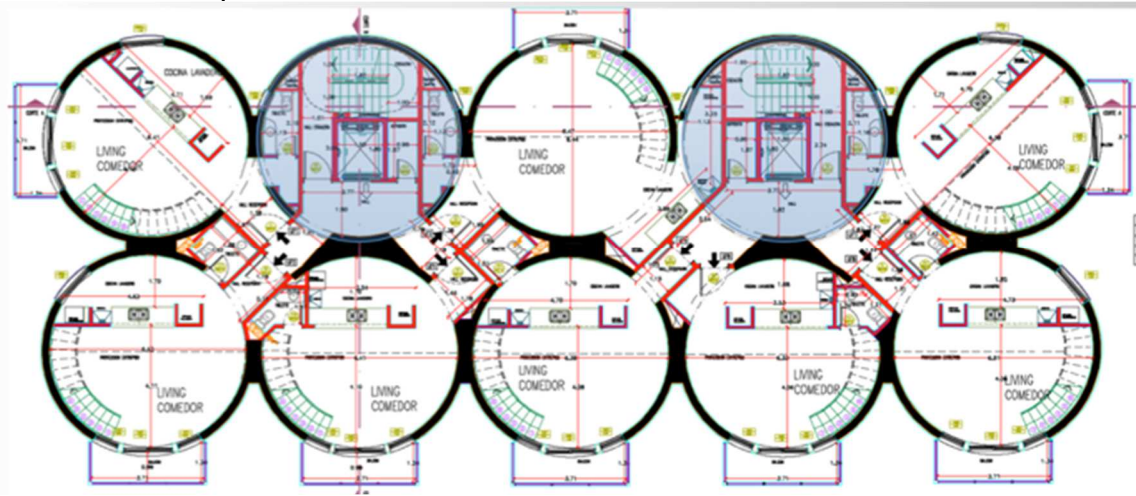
Planta Tipo de 1º-2º-3º-4º piso
